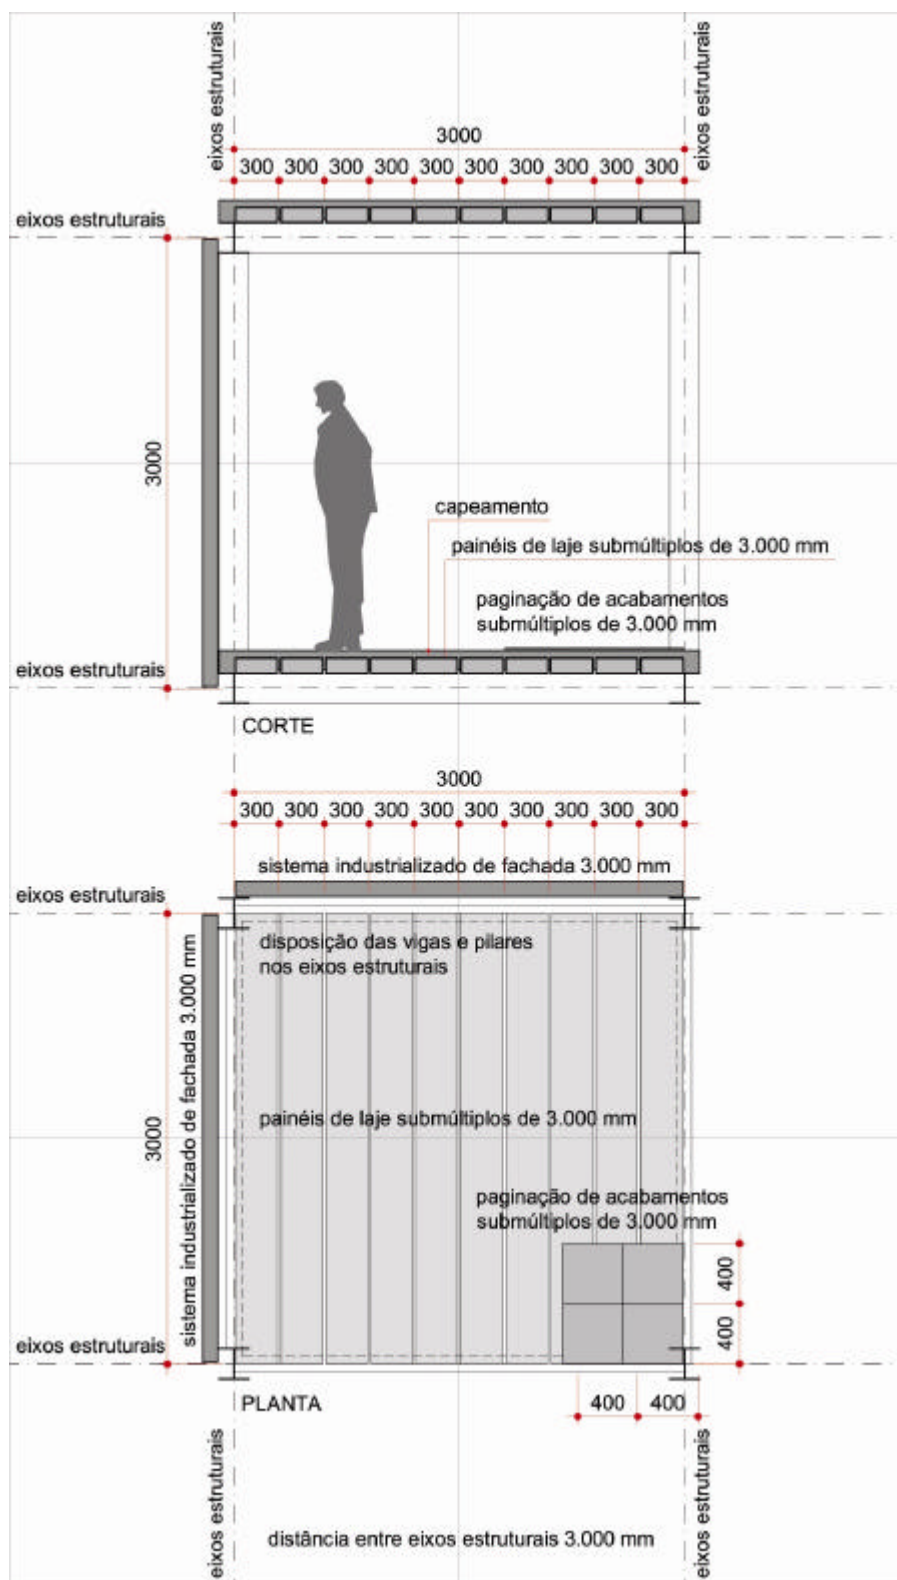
Coordenação modular entre estrutura, sistemas de lajes, sistemas de vedações e acabamentos. Planta e corte de um módulo típico – 3x3x3 m, com vedações externas.
